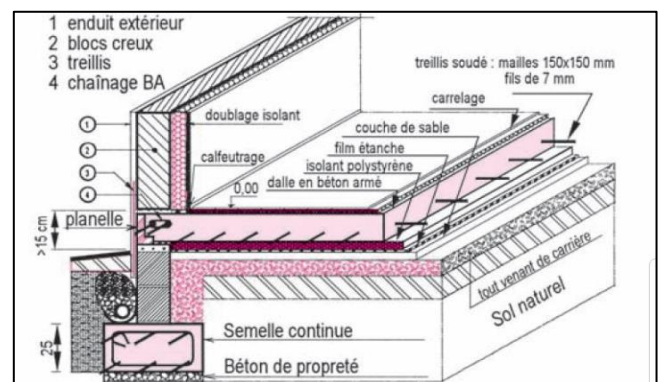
détail des composants du dallage sur hérisson source : Google image
